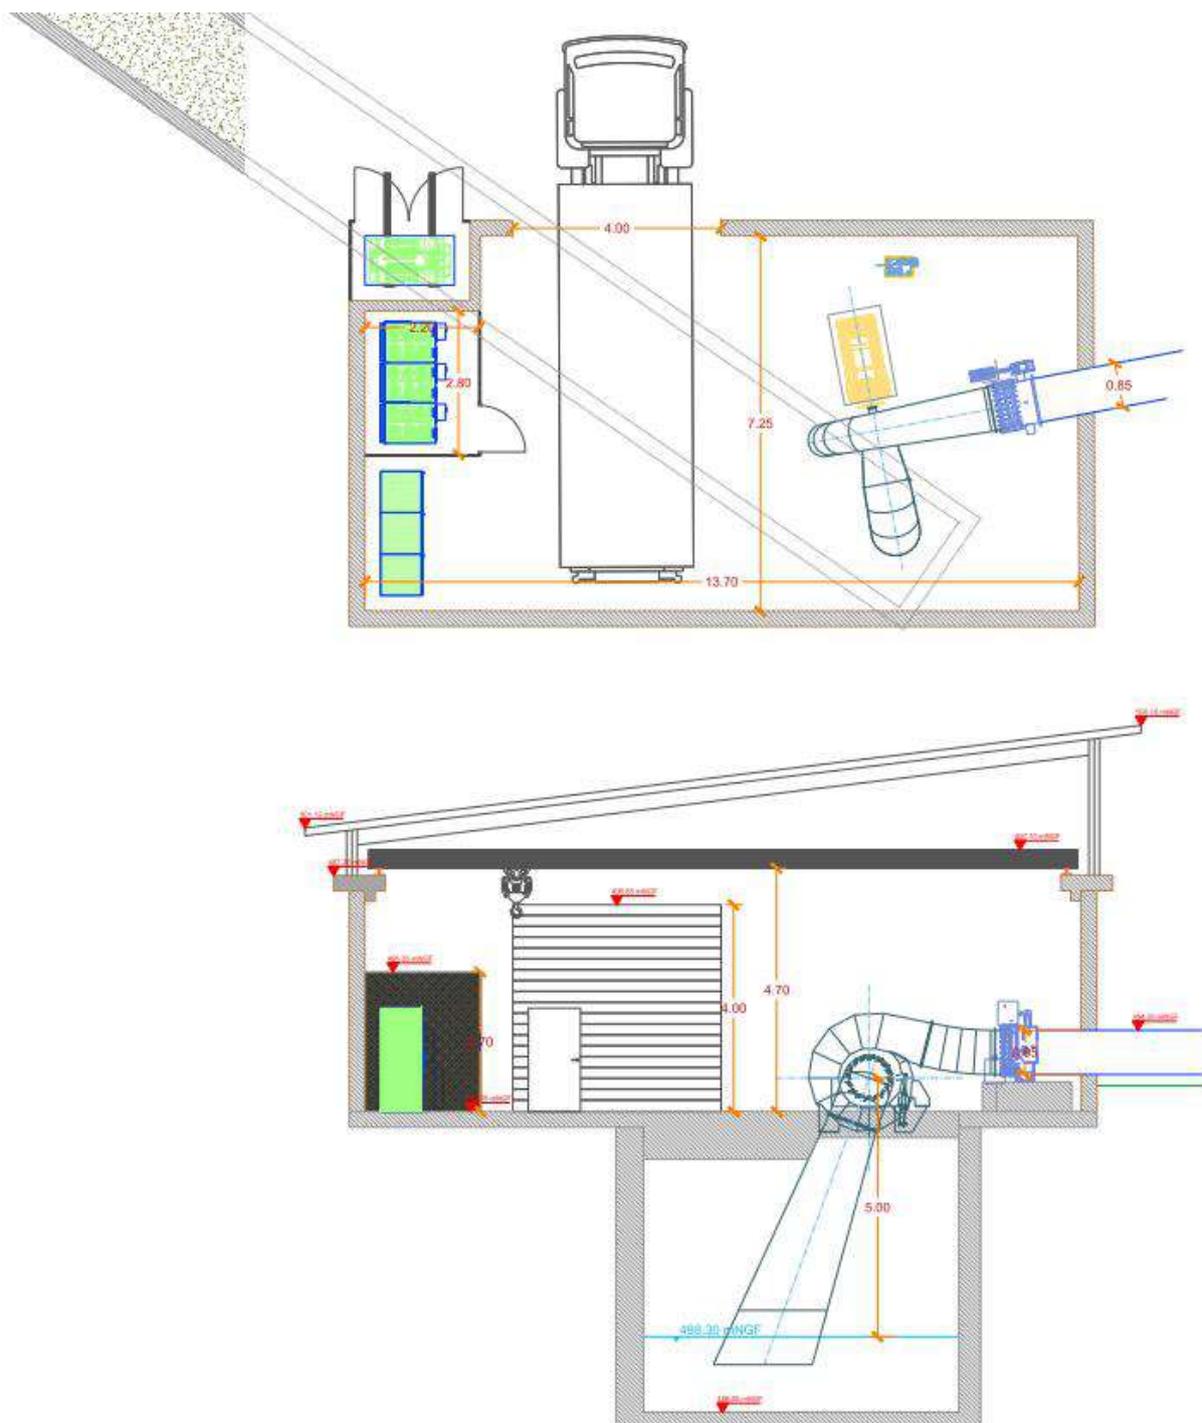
Plan massé, vue en plan et coupe de la centrale de Juralina (scénario variante : restitution des débits turbinés dans le canal de fuite actuel)
